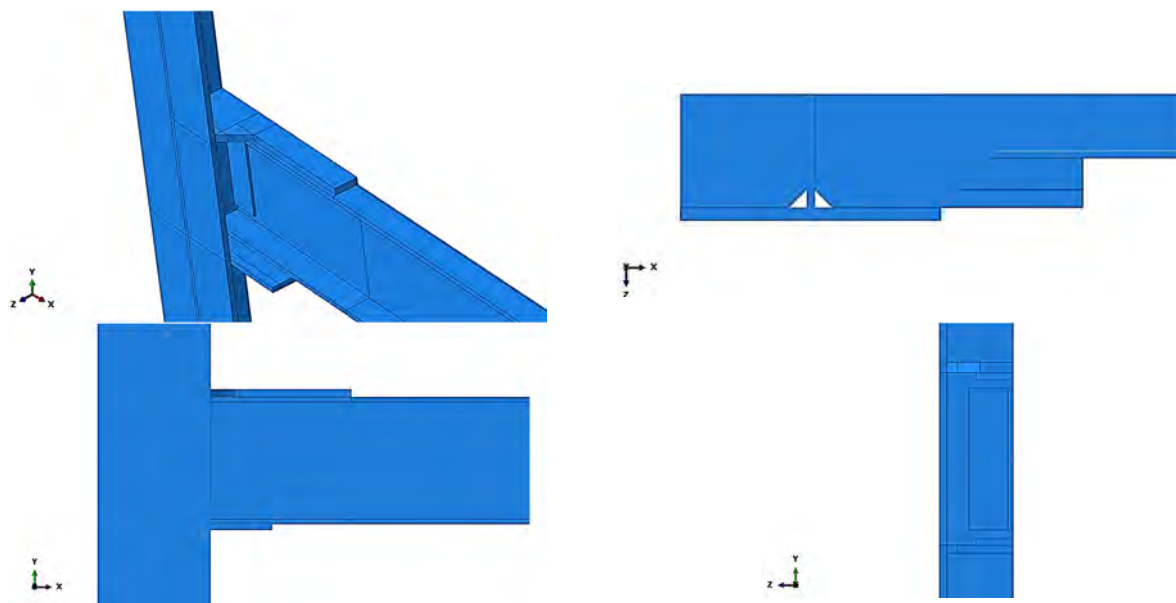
Vistas isométrica, superior, lateral y frontal respectivamente de la conexión soldada modelada en Abaqus.
